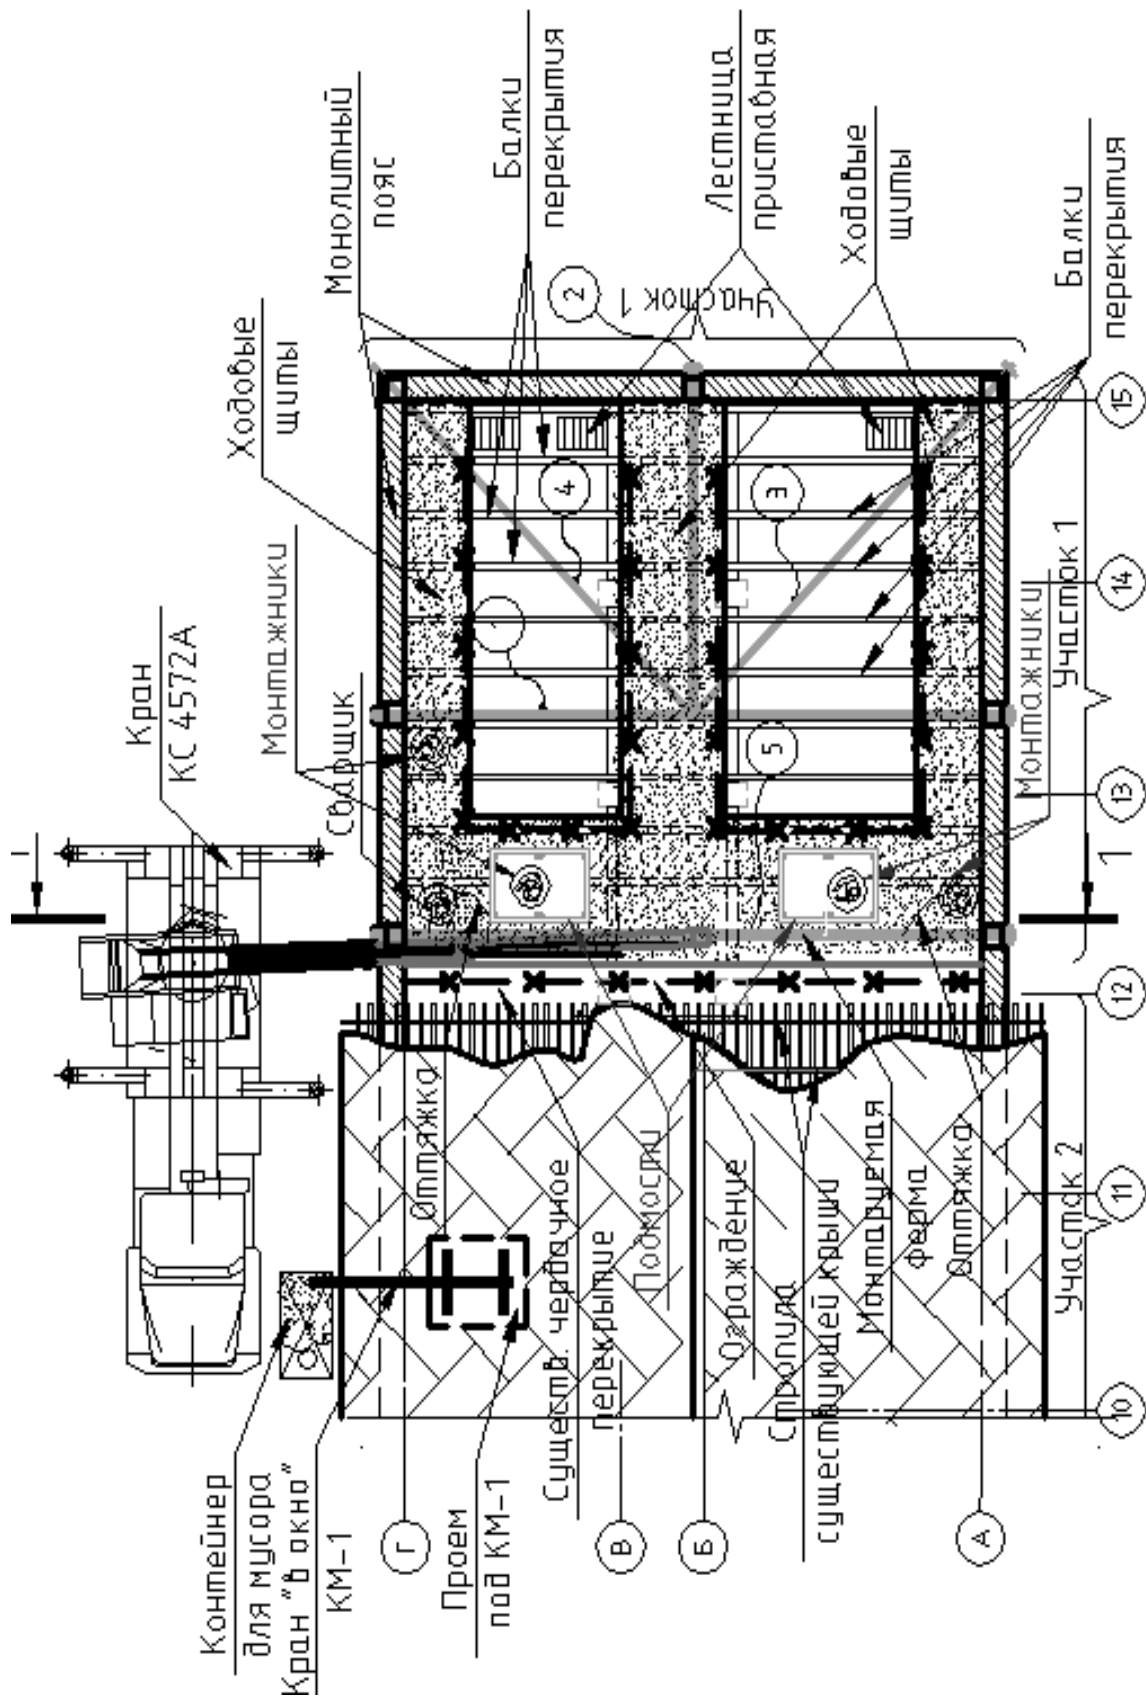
Схема выполнения работ по демонтажу-монтажу конструкций покрытия (1..5 – порядок монтажа ферм)
